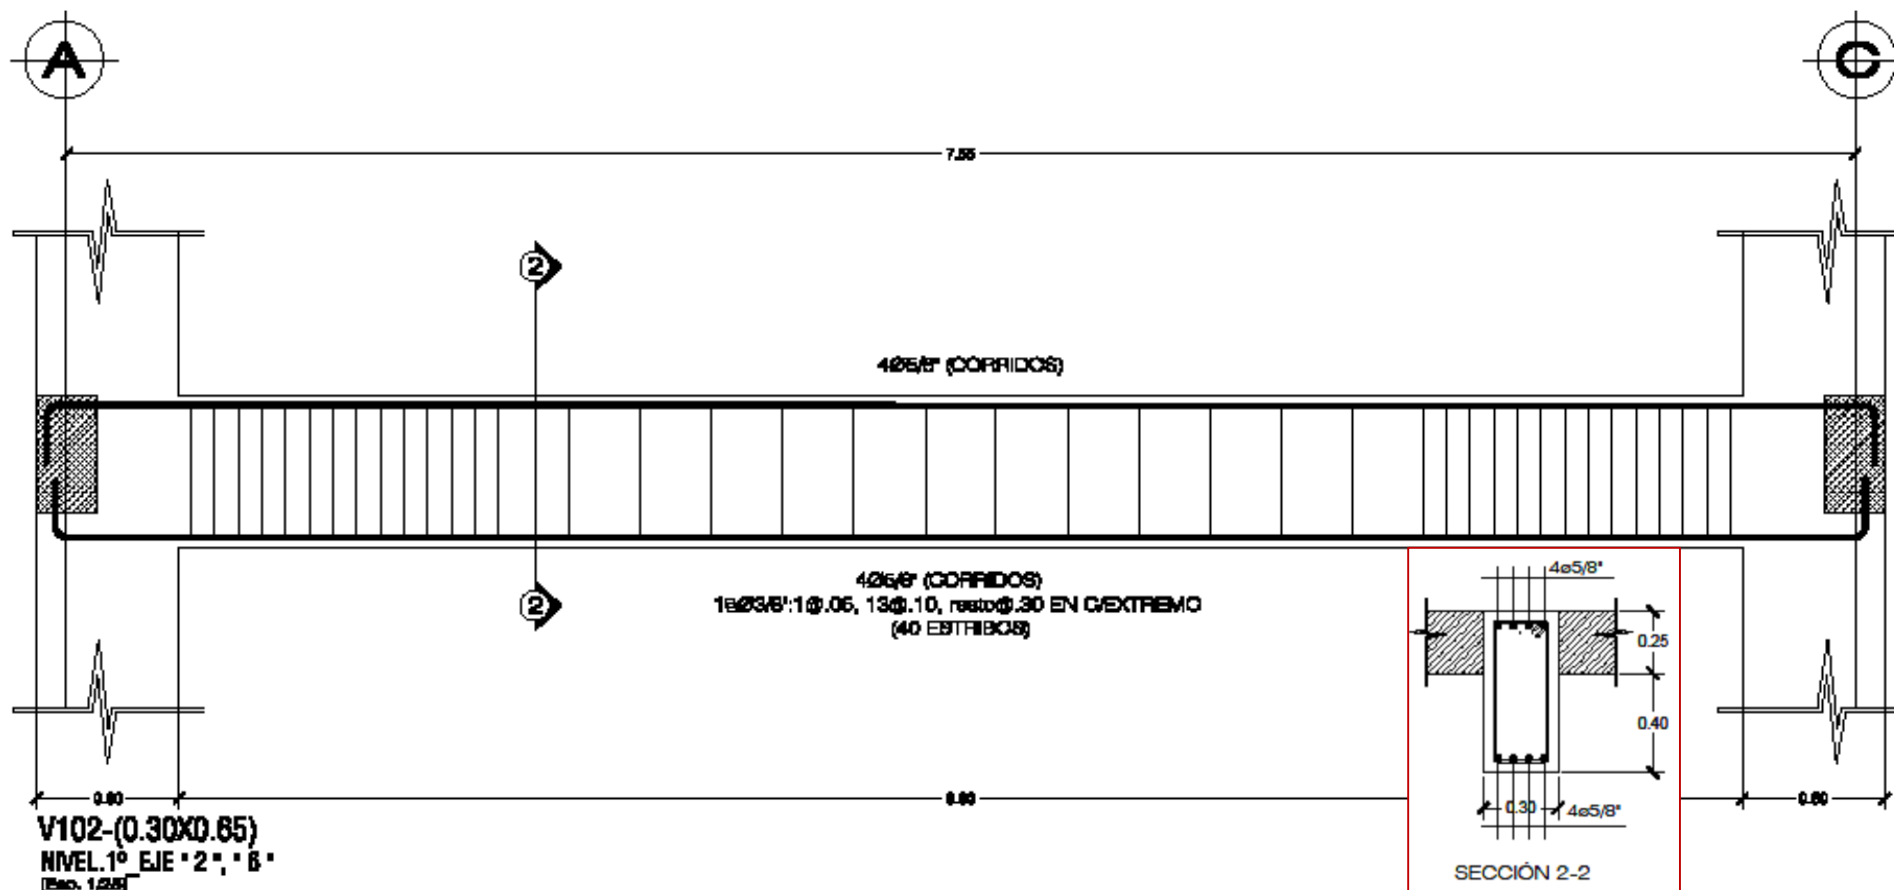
Disposición de Acero Longitudinal y Transversal de la Viga Ubicada en el Eje2=6 del Módulo de Aulas
